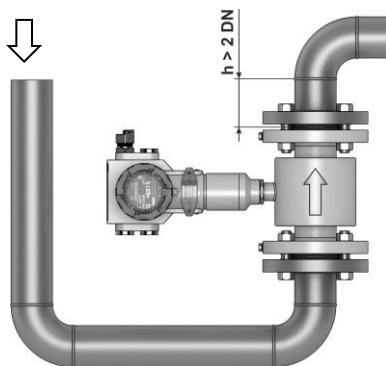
Монтаж расходомера в трубопровод с нисходящим потоком
